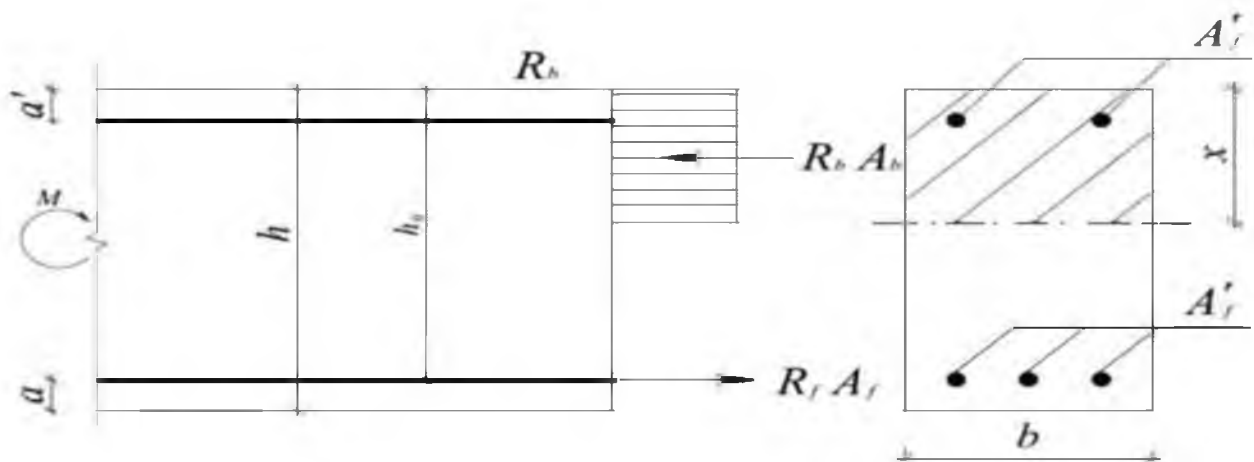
Схема усилий и эпюра напряжений в сечении, нормальном к продольной оси изгибаемой конструкции с композитной арматурой, при ее расчете по прочности.
